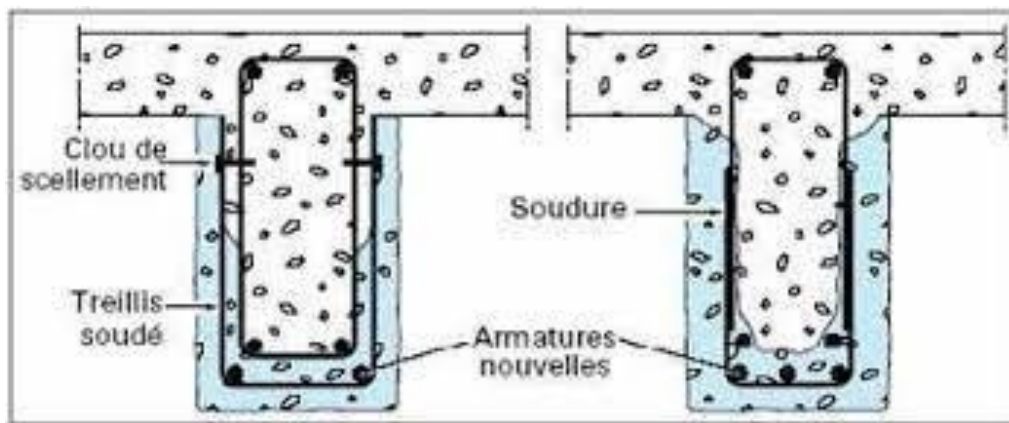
Armatures supplémentaires en surépaisseur de poutre []
